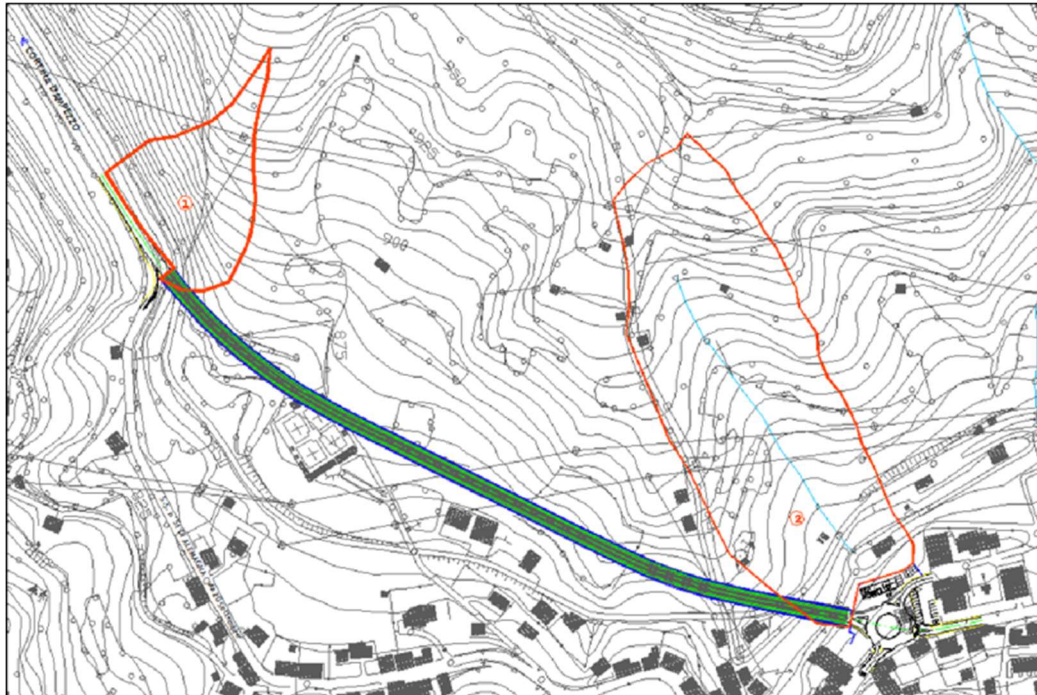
Planimetria ubicazione bacini acquiferi e tracciato di progetto
